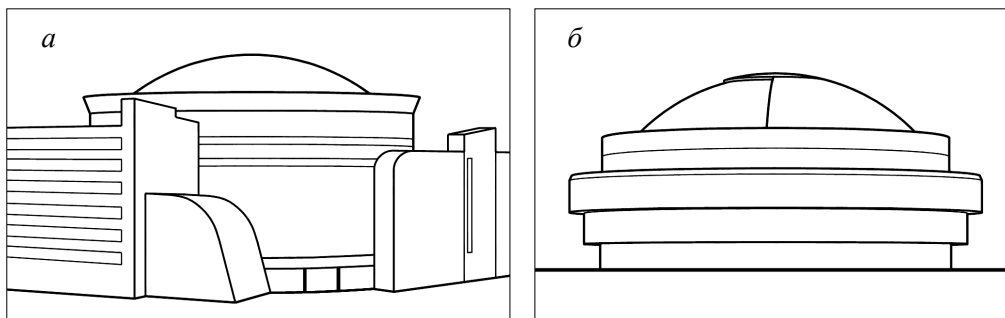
Здания с купольными покрытиями, при монтаже которых применялись строительные леса:
